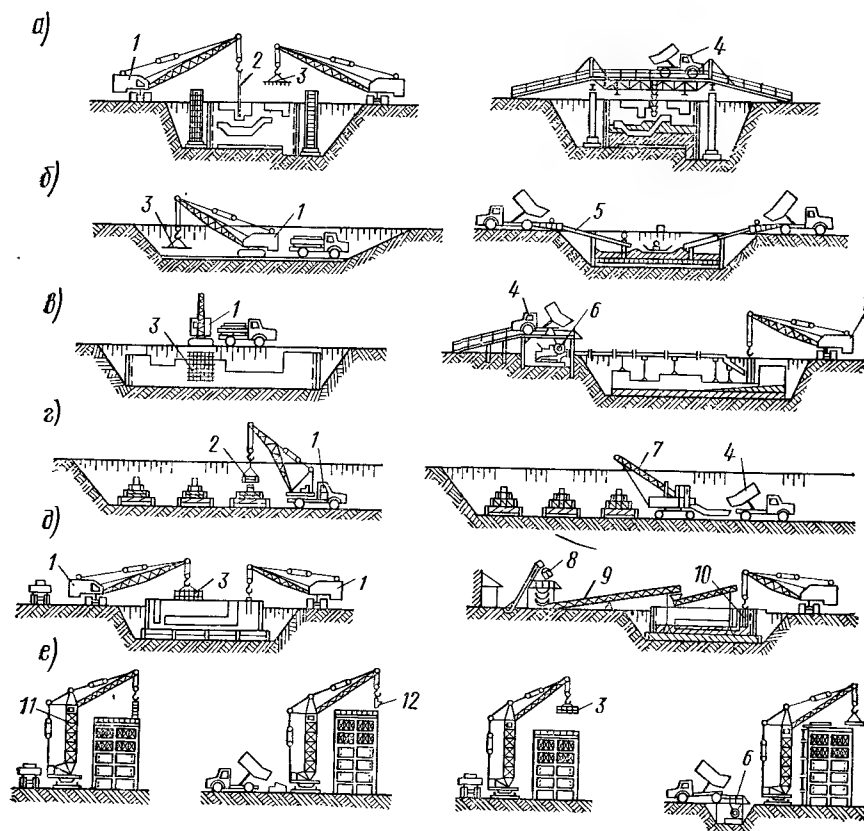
Схемы комплексной механизации железобетонных работ:
